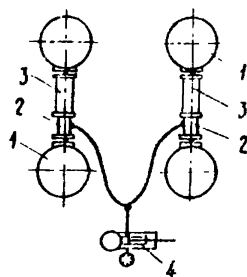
Схема испытания на горизонтальную нагрузку одновременно четырех свай:
